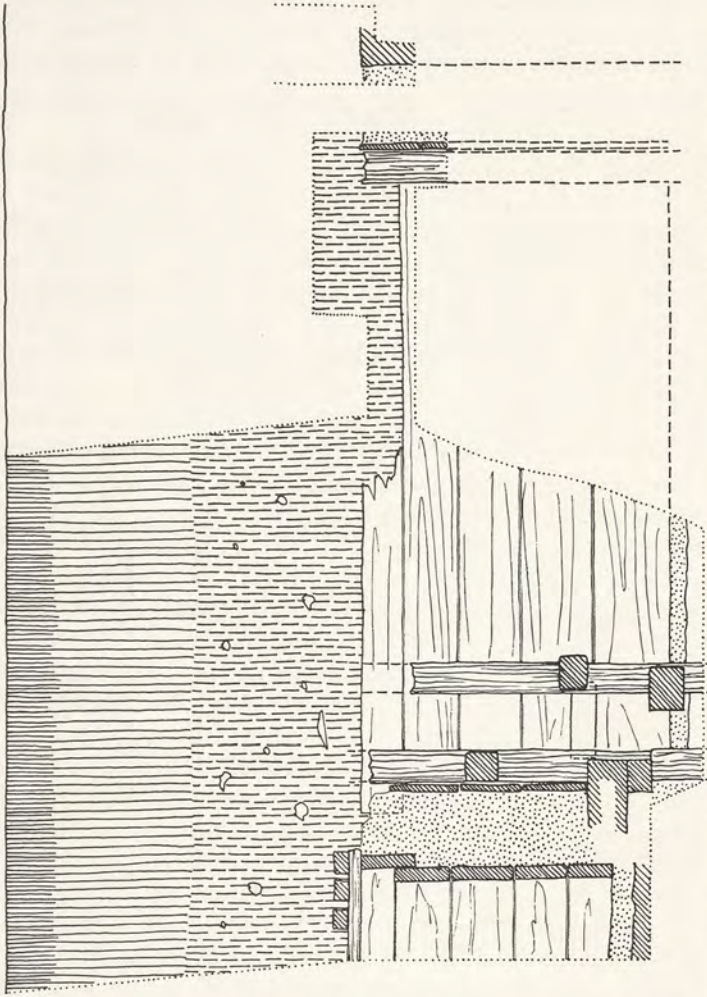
Grundriß einer römischen Brunnenstube in Schönbach
